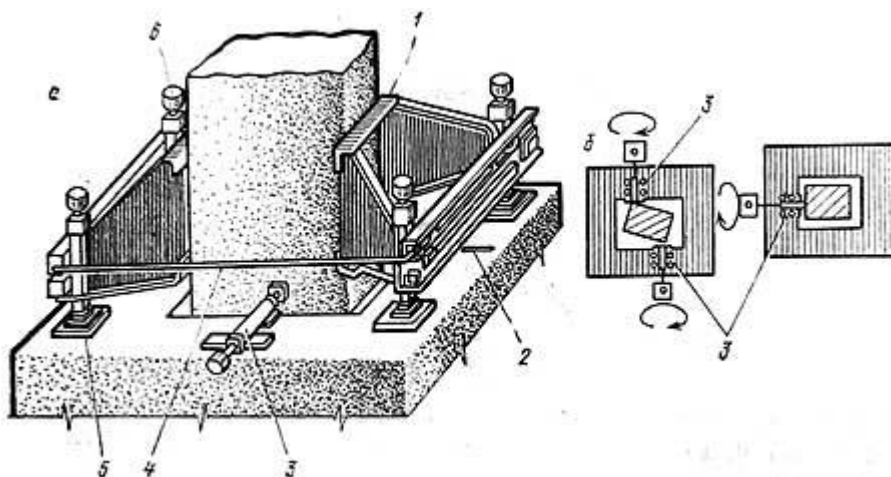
Кондуктор для закрепления колонны массой до 5 т в стаканы фундаментов: а — общий вид; б — схема рихтовки колонн в плане; 1 — корпус; 2 — риски; 3 — горизонтальный домкрат; 4 — стяжной болт; 5 — подкладки; 6 — винтовые домкраты кондуктора
